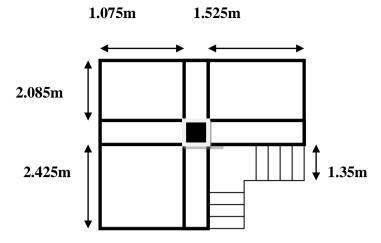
Poteau « P_1 » de la descente de charge.
